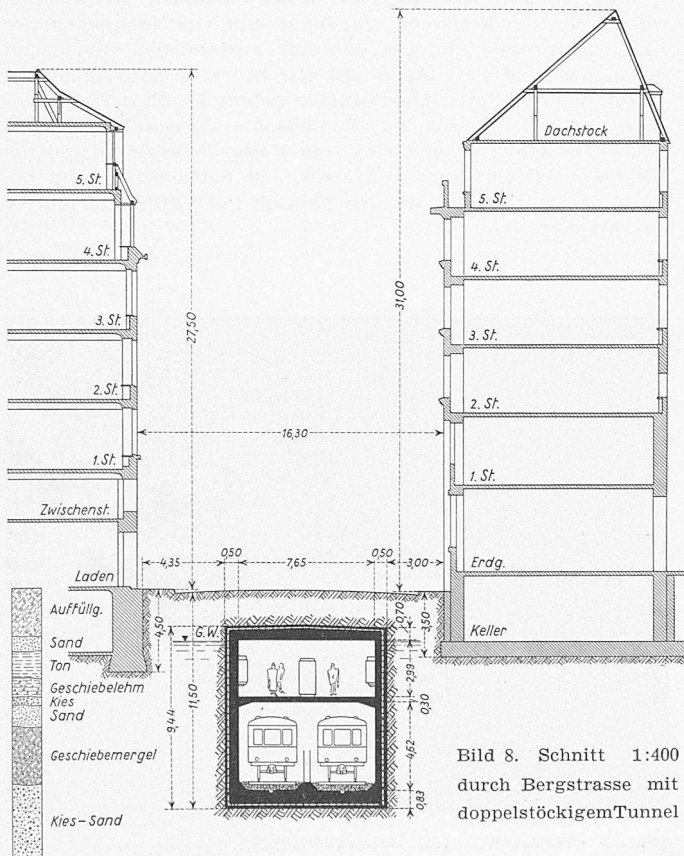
Schnitt 1:400 durch Bergstrasse mit doppelstöckigem Tunnel
